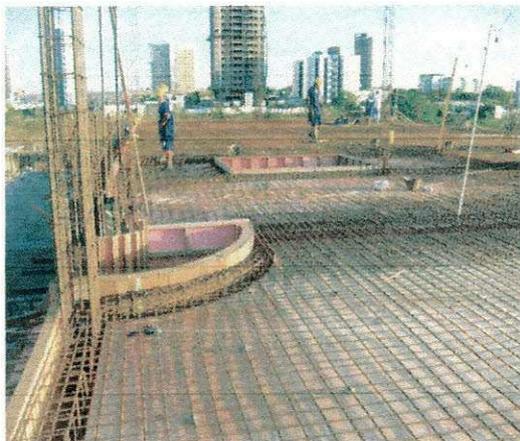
ARMAÇÃO DA LAJE MACIÇA
